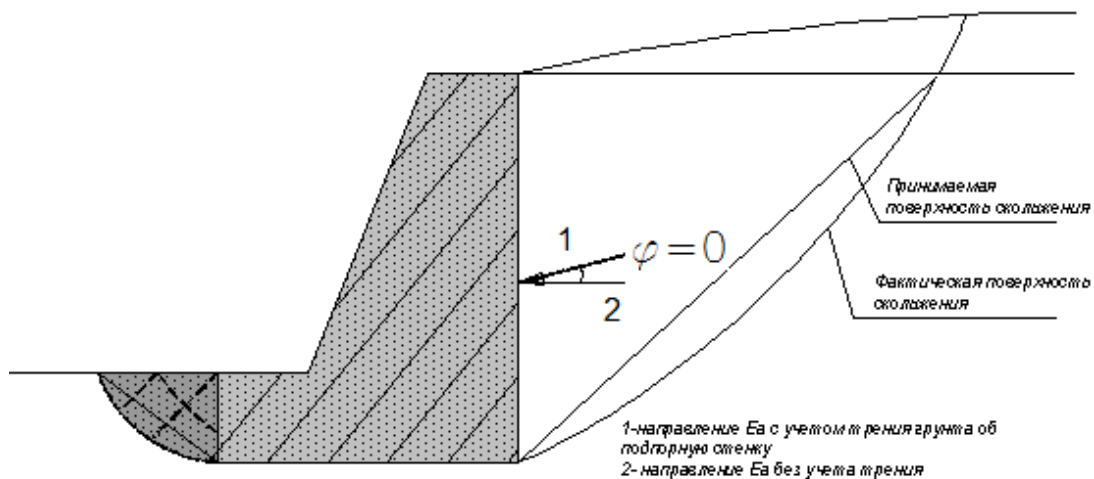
Расчетная схема к определению давления грунта на подпорную стенку с учетом принятых допущений
